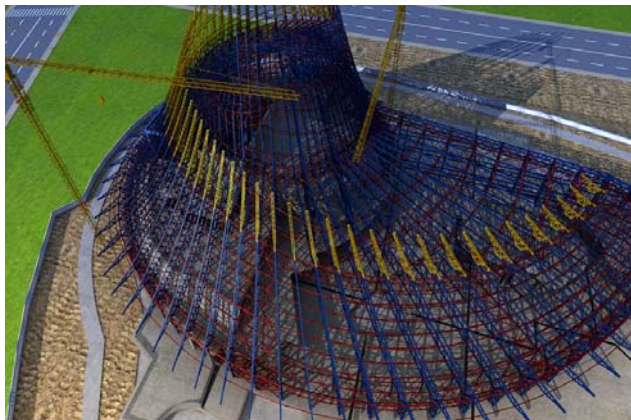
钢结构安装钢结构施工动漫演示方案
